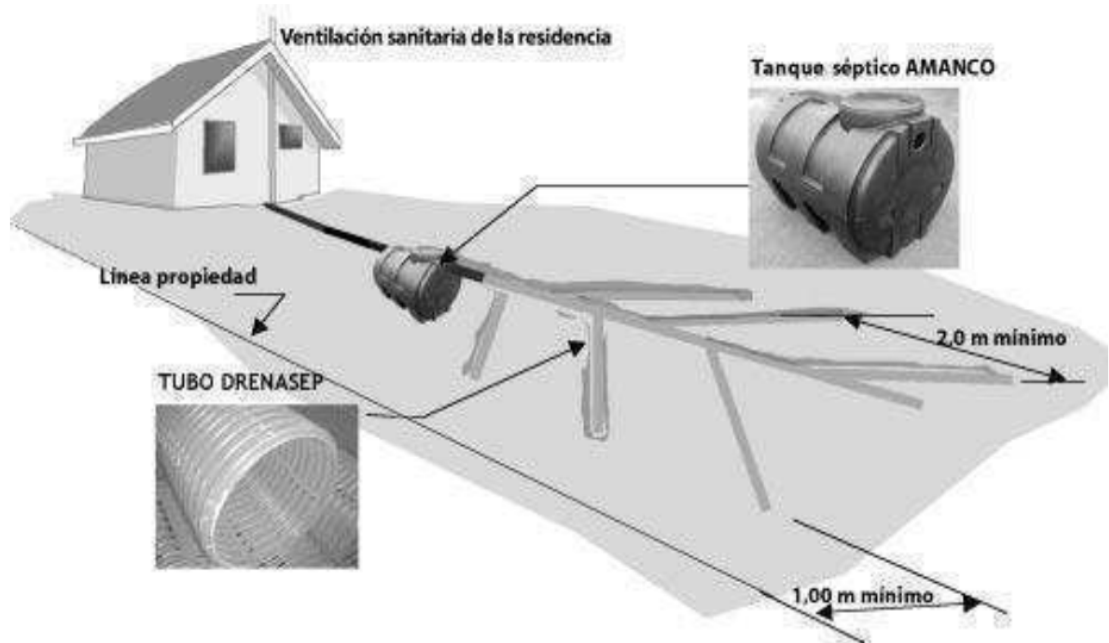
Sistema Drenaje para drenaje de tanques sépticos. Fuente AMANCO.
